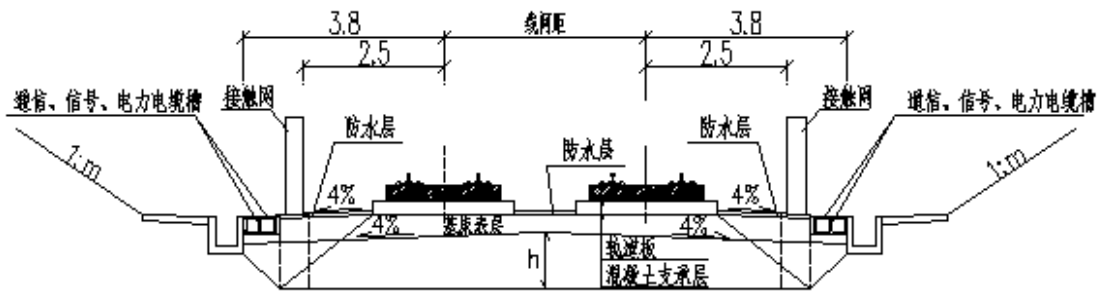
无砟轨道双线非硬质岩路堑横断面示意图（单位：m）
